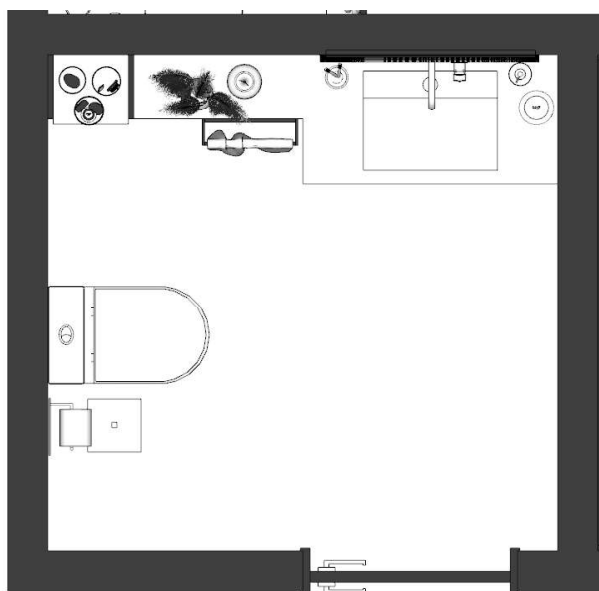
Planta s/escala, Instalação sanitária de serviço. *Fonte:* Autora.
